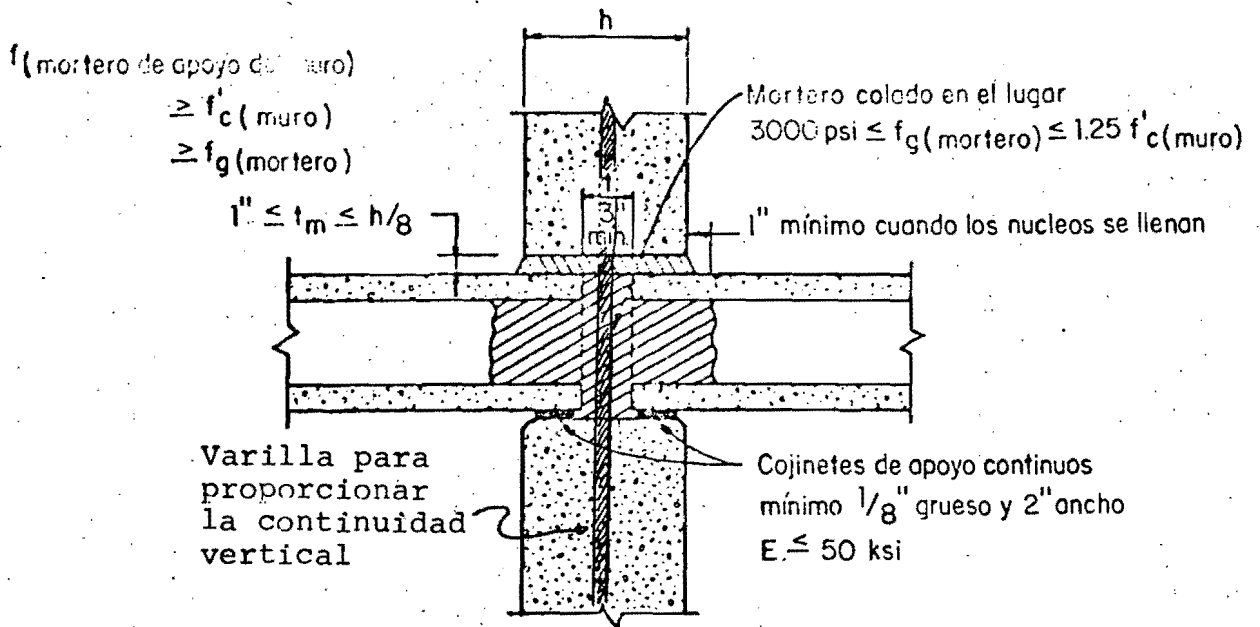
Detalles de una conexión horizontal interior muro-losa-muro típica de E.U. con mortero (ref 8)
